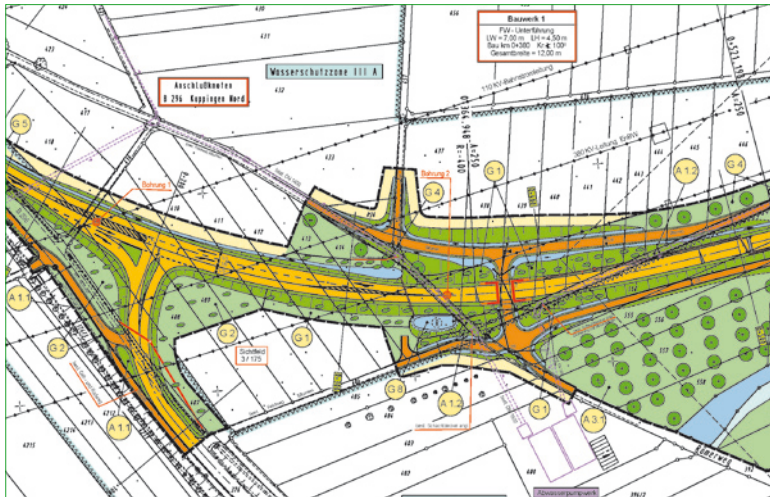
K 1081, Nordumfahrung Herrenberg, Bebauungsplan (Ausschnitt)
